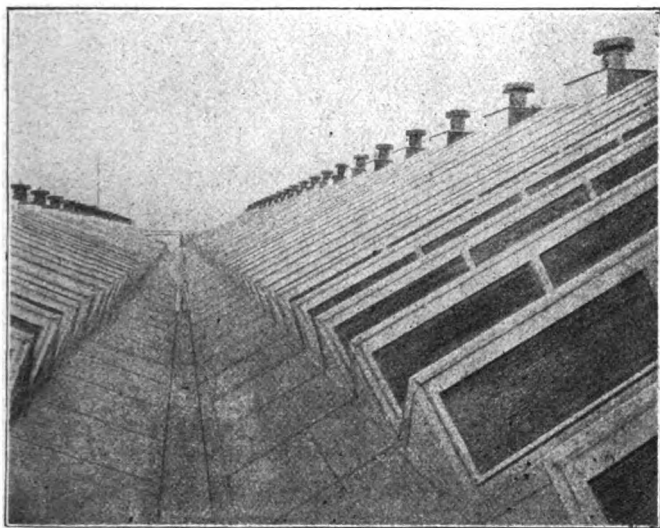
Z. A.: Die neue Fabrikanlage der Boyer Machine Co. in Detroit.
